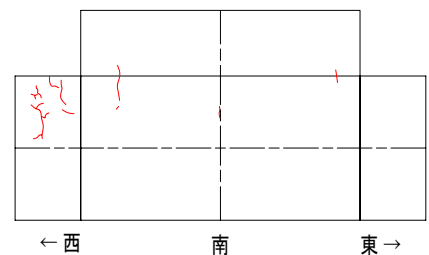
model-d(鉄筋比 1.98%)のひび割れ状況
